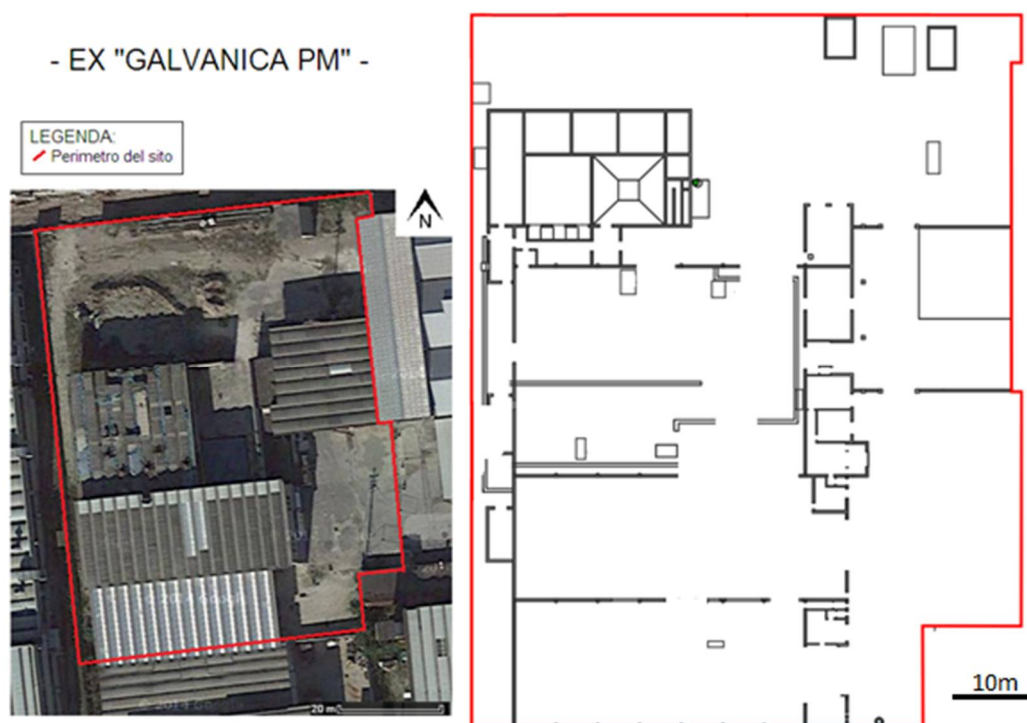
Foto aerea e planimetria dell'area ex "Galvanica p.m.". Foto gennaio 2015.
